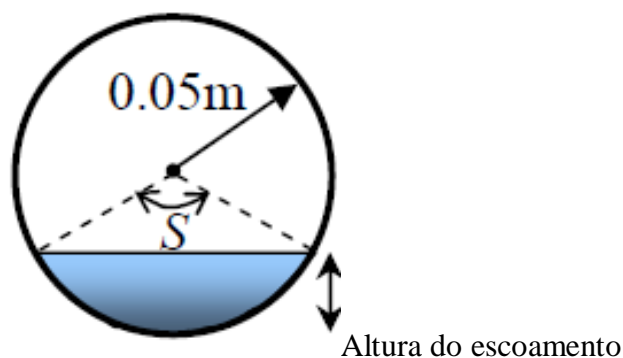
Secção transversal do ramal de ligação (Lee, Wong, et al., 2010)
